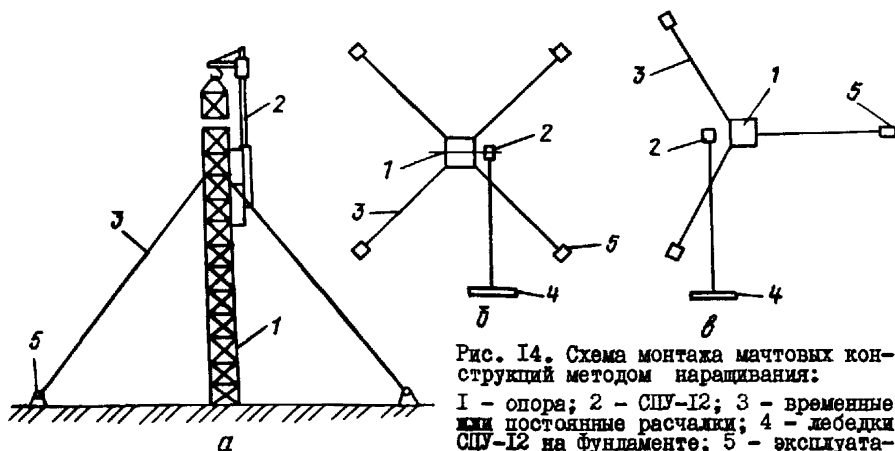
Схема монтажа мачтовых конструкций методом наращивания:
